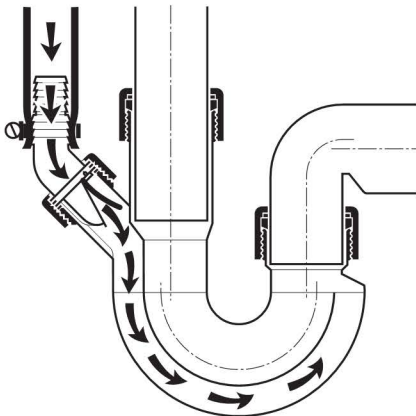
Entleerung Spül- oder Waschmaschine über Doppelkammer
